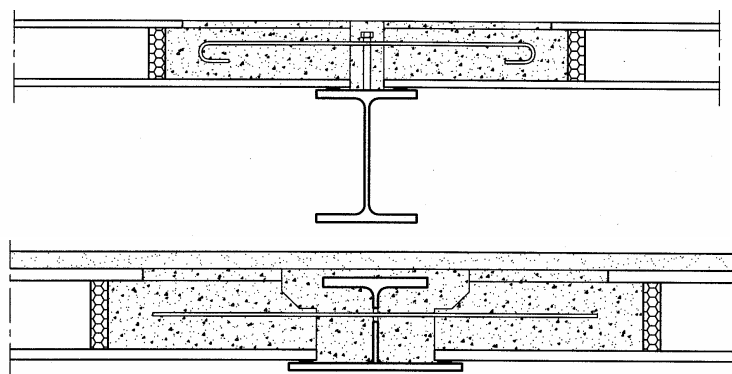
Exemplos de pisos apoiados em vigas metálicas
